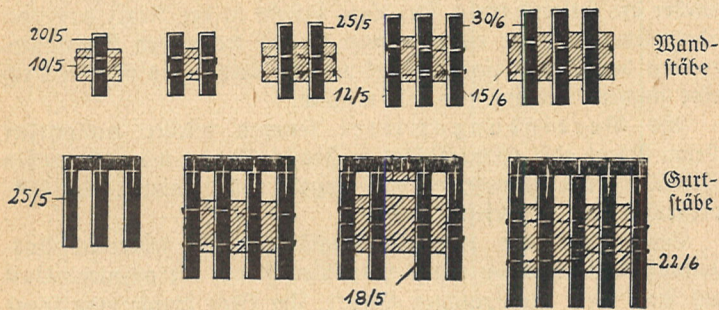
Querschnittsformen für Fachwerkstäbe aus Brettern und Bohlen.
